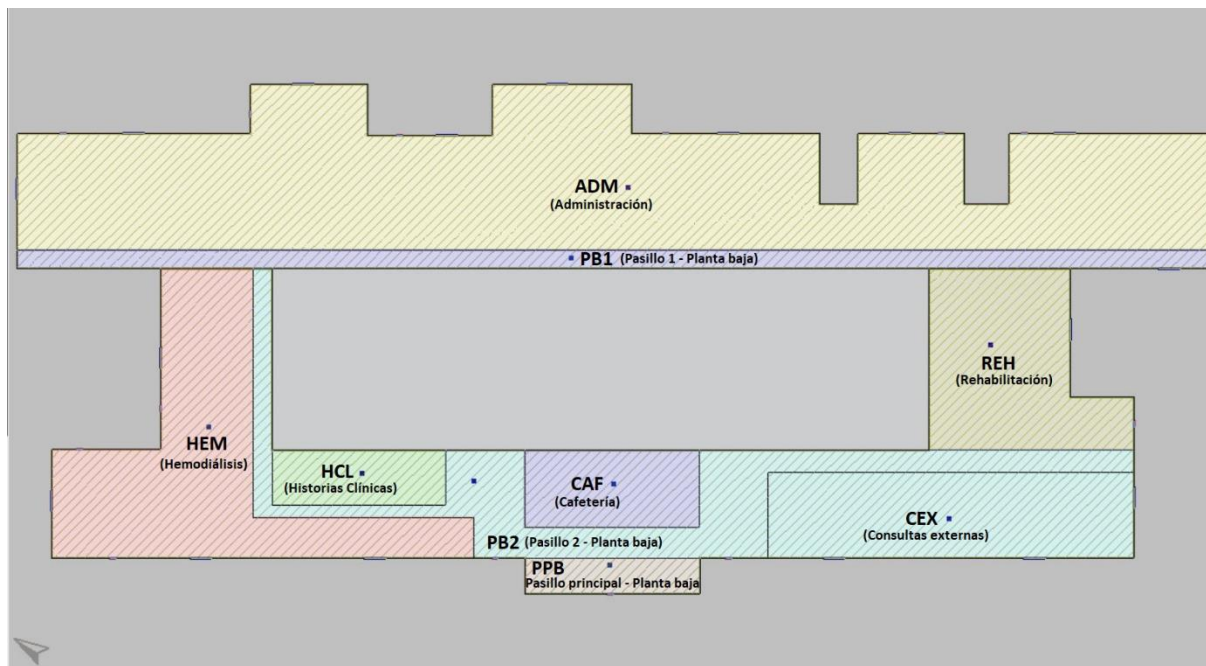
Modelado de planta baja del Hospital en CYPECAD MED
